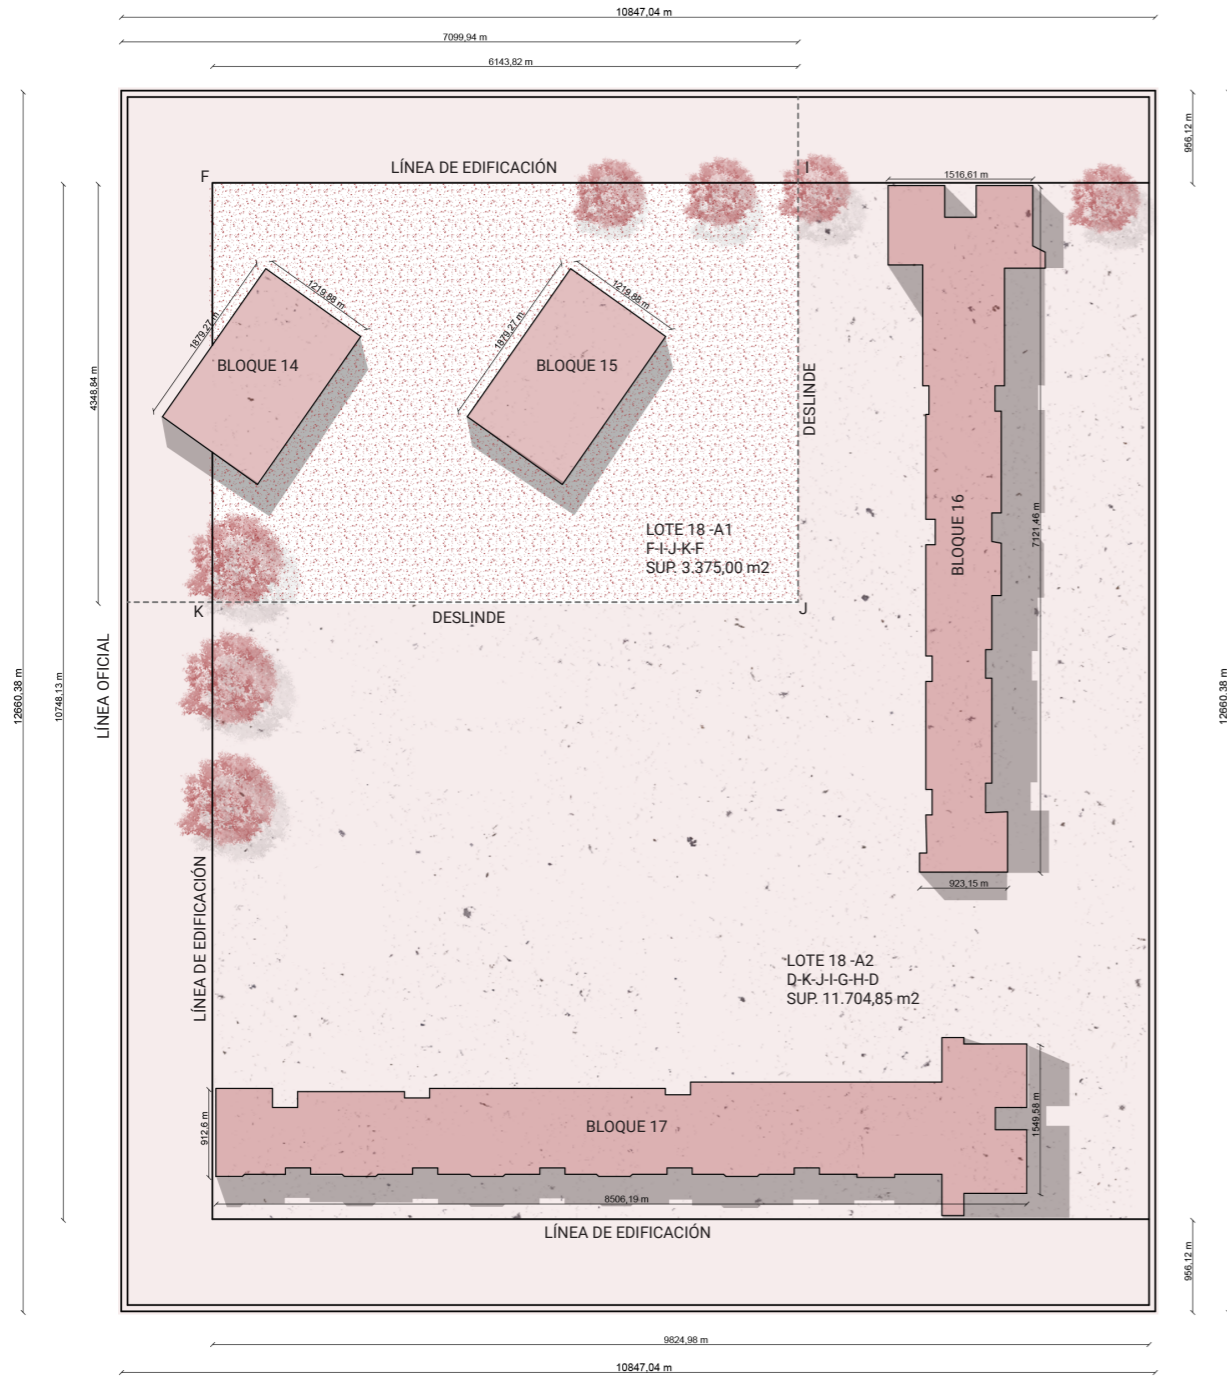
Planta de la manzana original del proyecto Villa San Luis | Esc. 1:100
